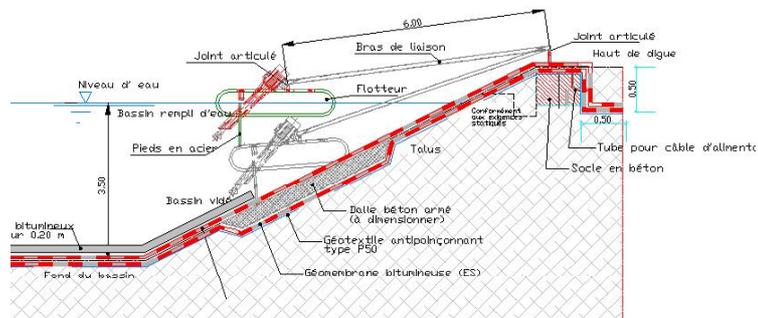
Dispositions constructives de protection sous un aérateur de lagune
